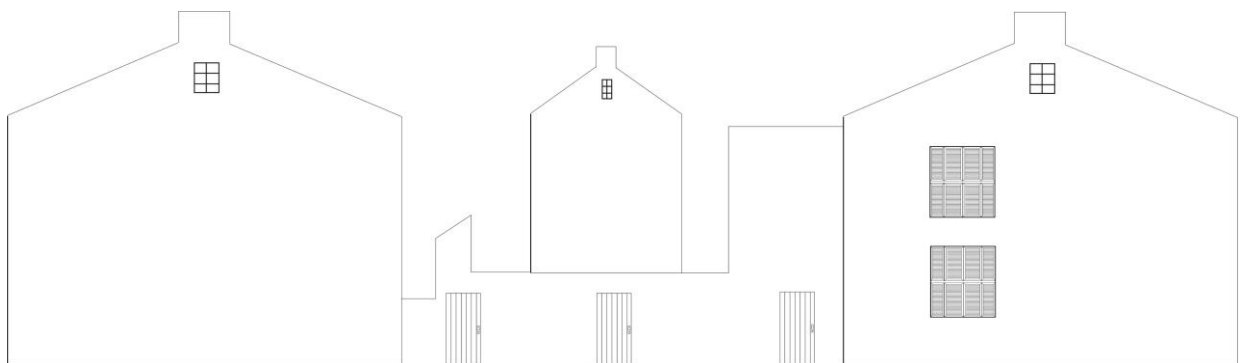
Croqui da lateral direita do Grupo A1 e A2. Da esquerda para direita: Lateral da casa número 410, seguida pelo muro que separa a viela do quintal da casa. Ao centro está representado a casa número 404-1, cuja entrada principal é por este muro lateral. Em seguida, lateral da casa número 404- 2. Nota-se que cada casa disposta ao lado da viela possui uma entrada lateral para o quintal.
